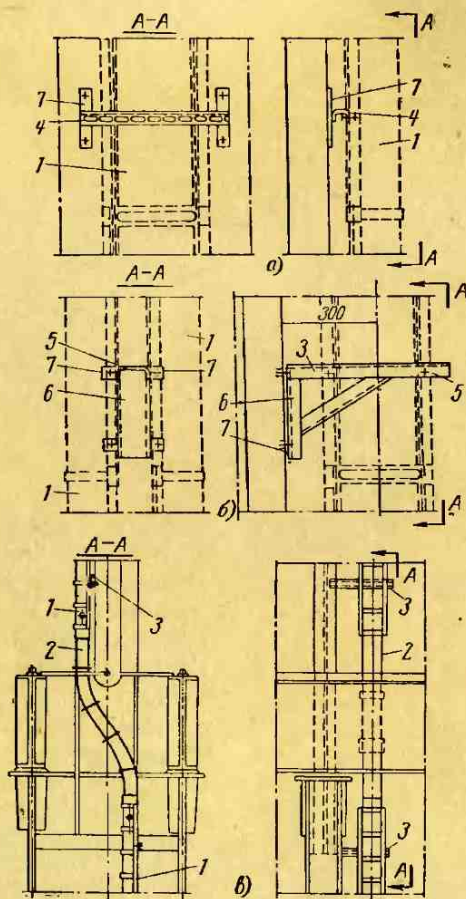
Вертикальная прокладка магистральных шинопроводов на стене или колоннах.
